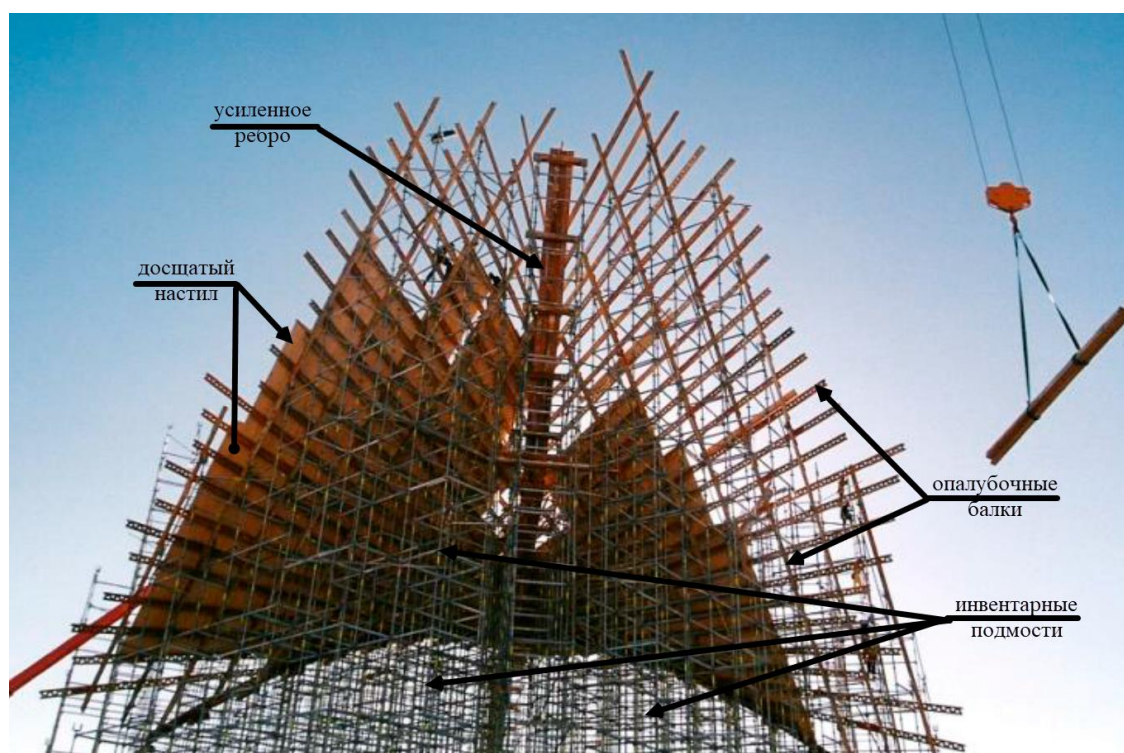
Принципиальная схема устройства опалубки для сооружения монолитных оболочек покрытия
